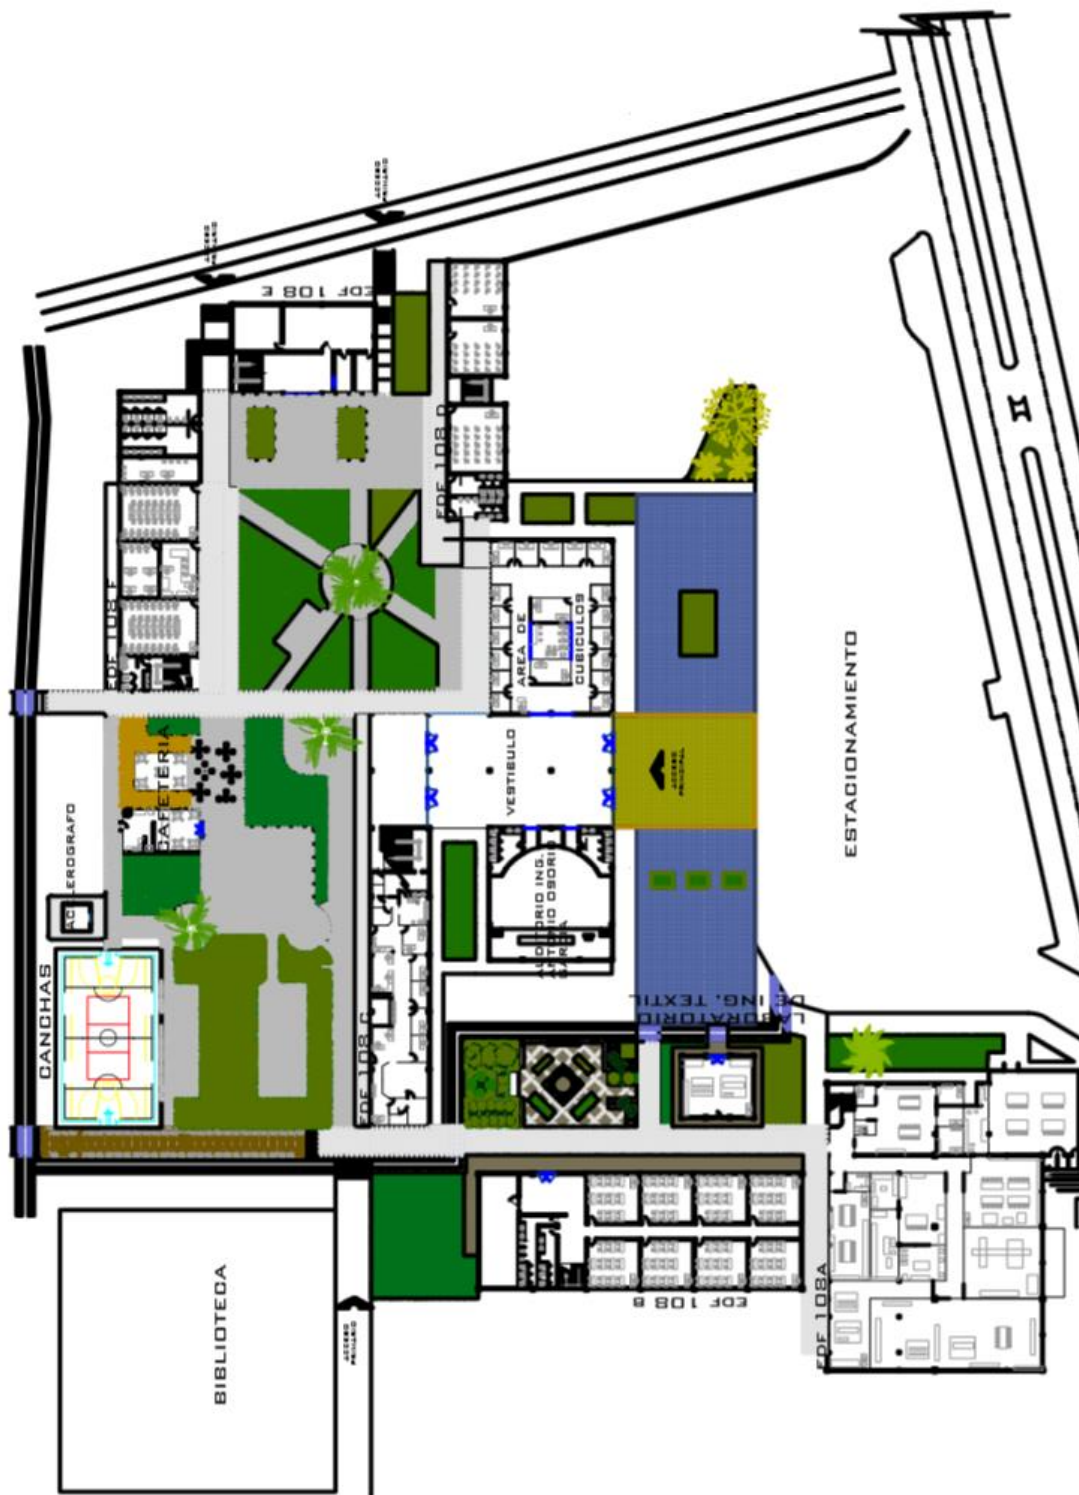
Plano general de la Facultad de Ingeniería BUAP
